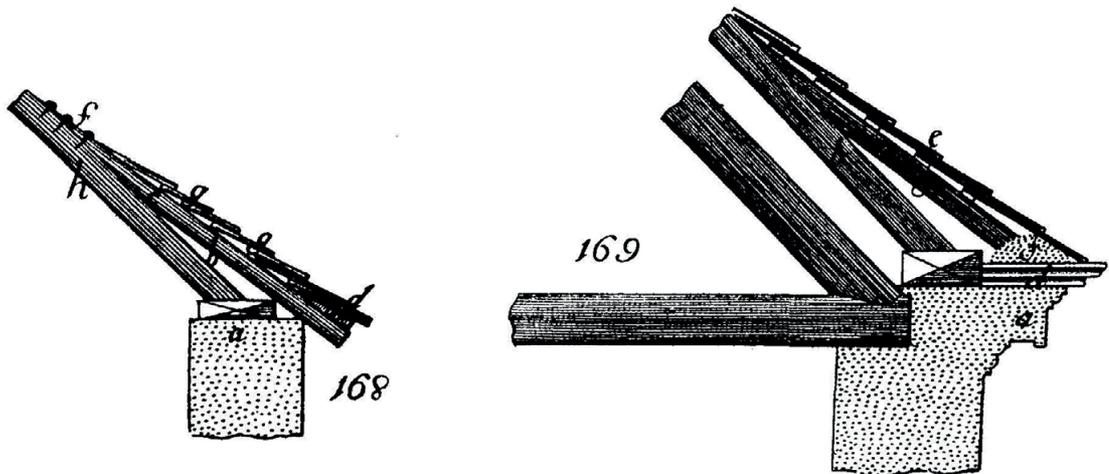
Cubiertas de pizarra. (168) Alero corrido, (169) Alero de mesilla (Bails 1796, 334).
